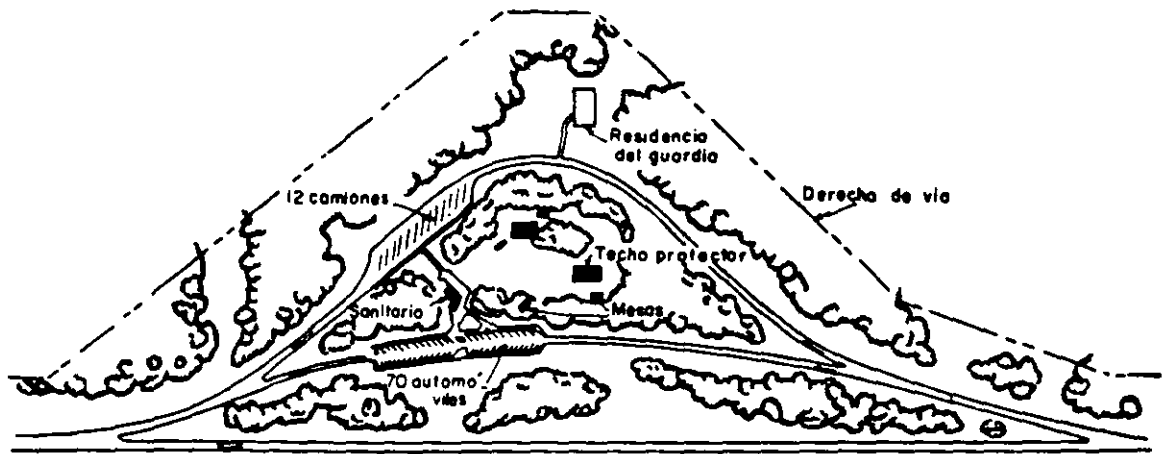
ZONA DE DESCANSO CON CASETA DE VIGILANCIA PARA REDUCIR EL VANDALISMO
